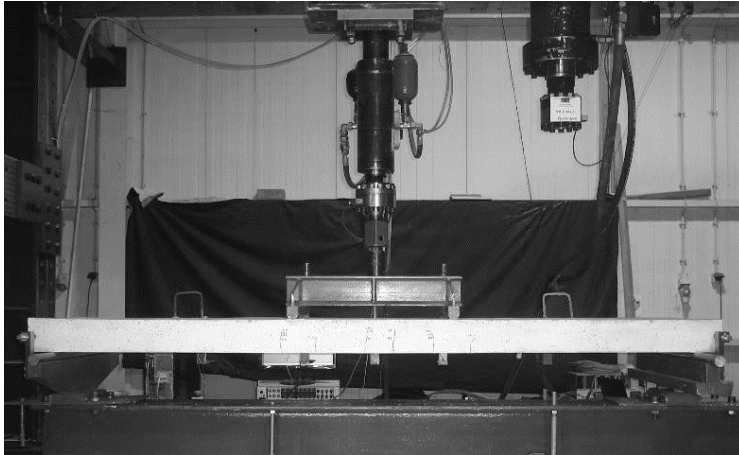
Esquema geral do ensaio à flexão das lajes de betão armado.
